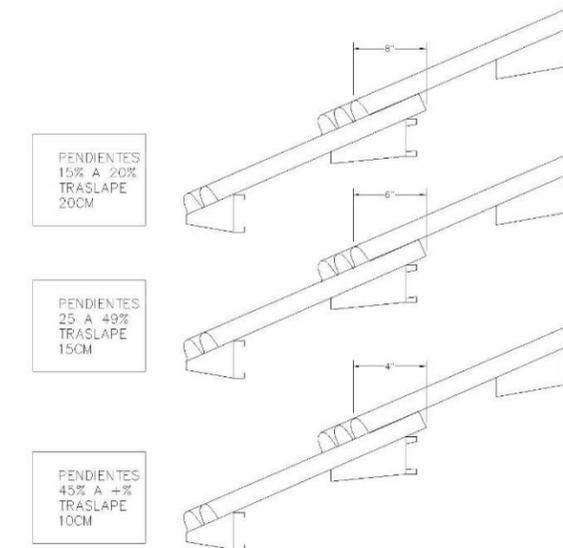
Traslape de zinc según pendiente. Fuente: equipo de trabajo
